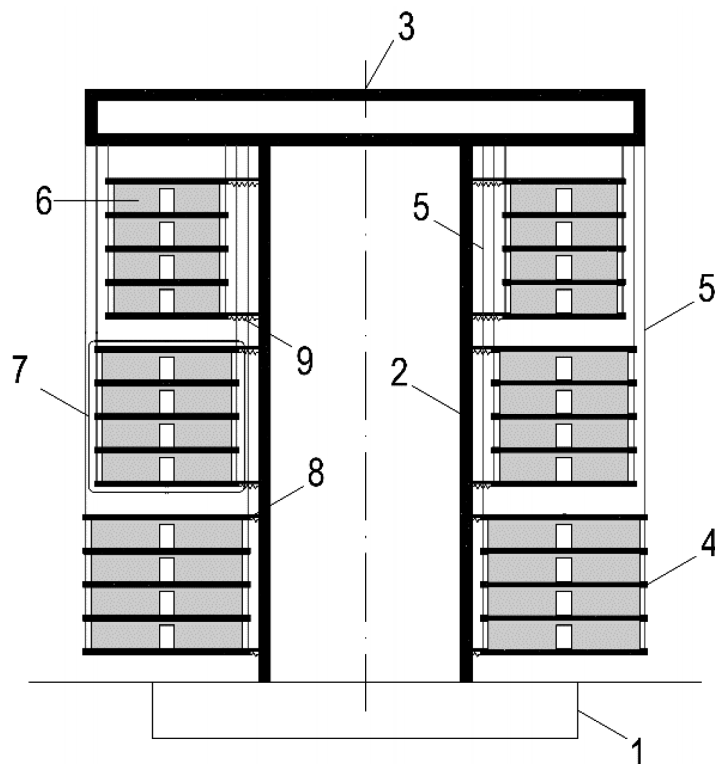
Здание с подвешенными блоками этажей: 1 – фундамент; 2 – несущий ствол; 3 – консольный ростверк; 4 – плиты перекрытий; 5 – подвески; 6 – диафрагмы жесткости; 7 – геометрически неизменяемые блоки этажей; 8 – выключающиеся связи; 9 – упругие связи
